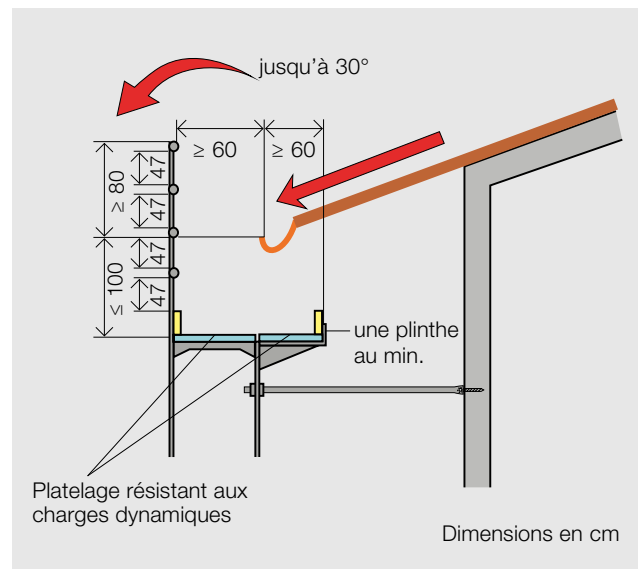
remplacement du chéneau ou de tuiles sur un toit existant
